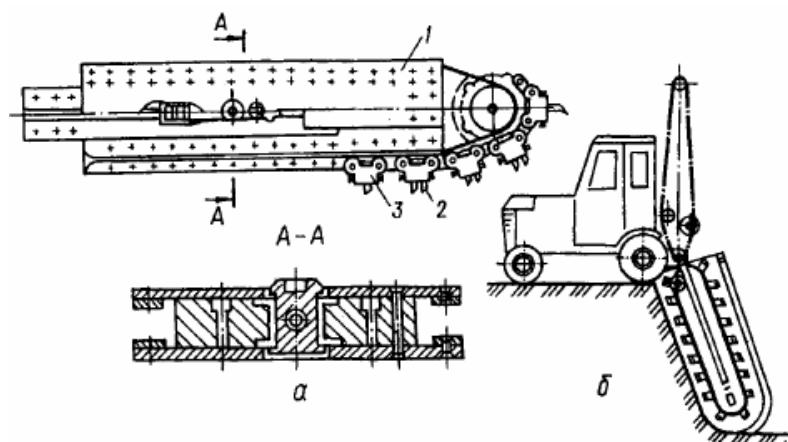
Барові розпушувачі: а - баровий ланцюг (1 - корпус; 2 - різець; 3 - каратка); б - на базі колісного 'фактора'
